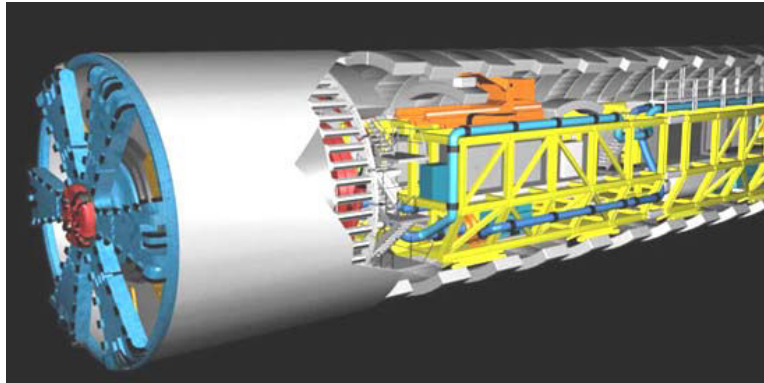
Tunnelier : TBM (Tunnel Boring Machine) [6]
